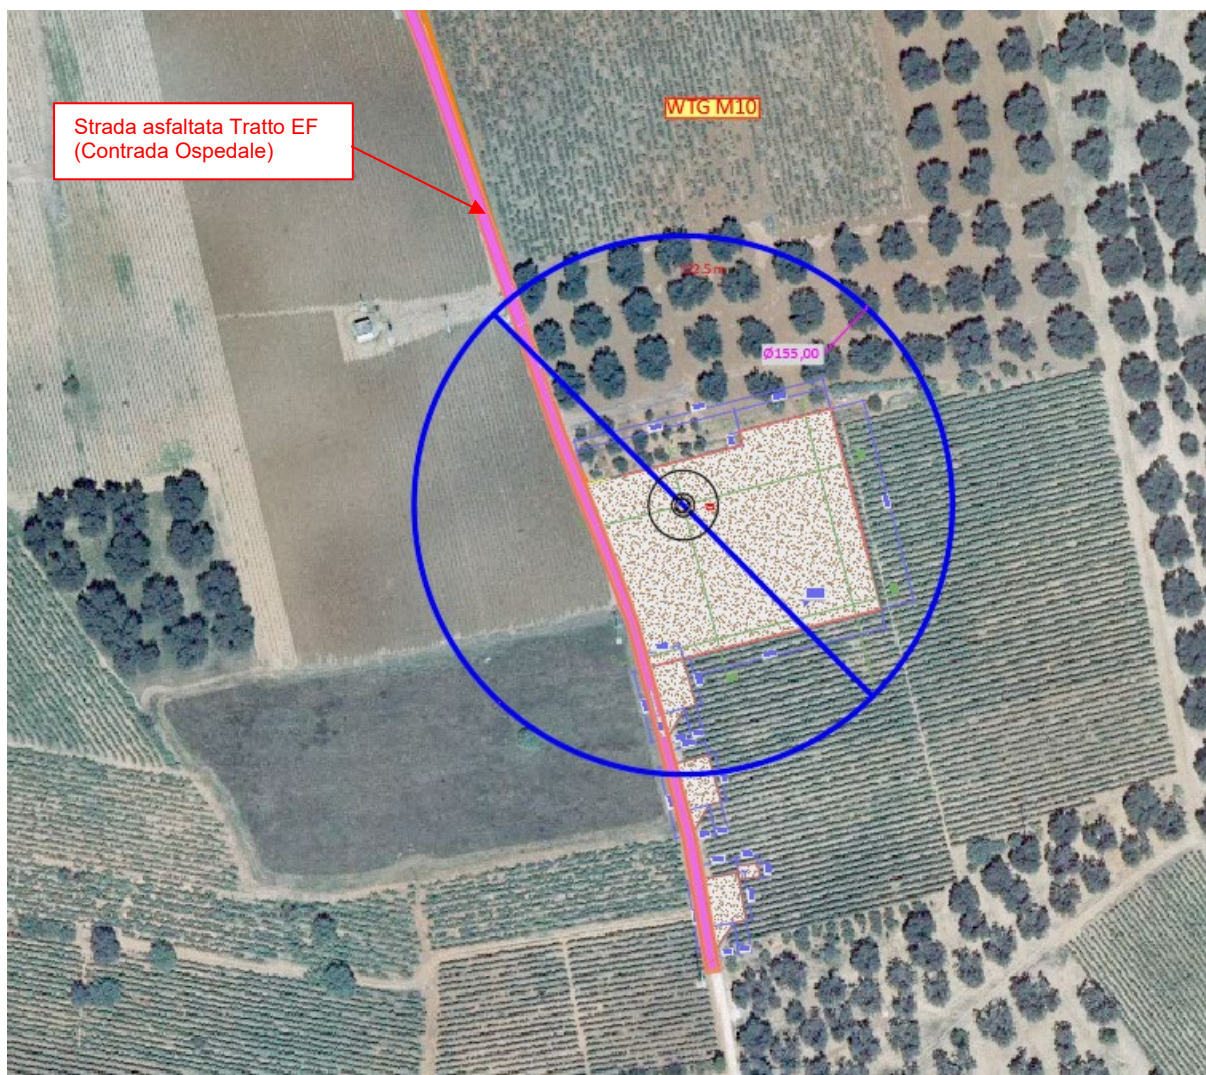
stralcio su ortofoto con individuazione della viabilità per raggiungere la torre WTG M10
